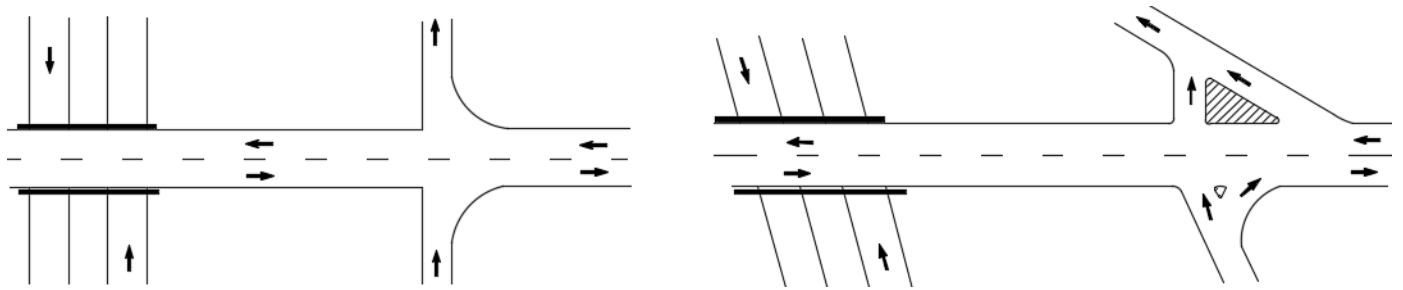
Proyectos de caminos transversales de dos carriles para desalentar el acceso equivocado
